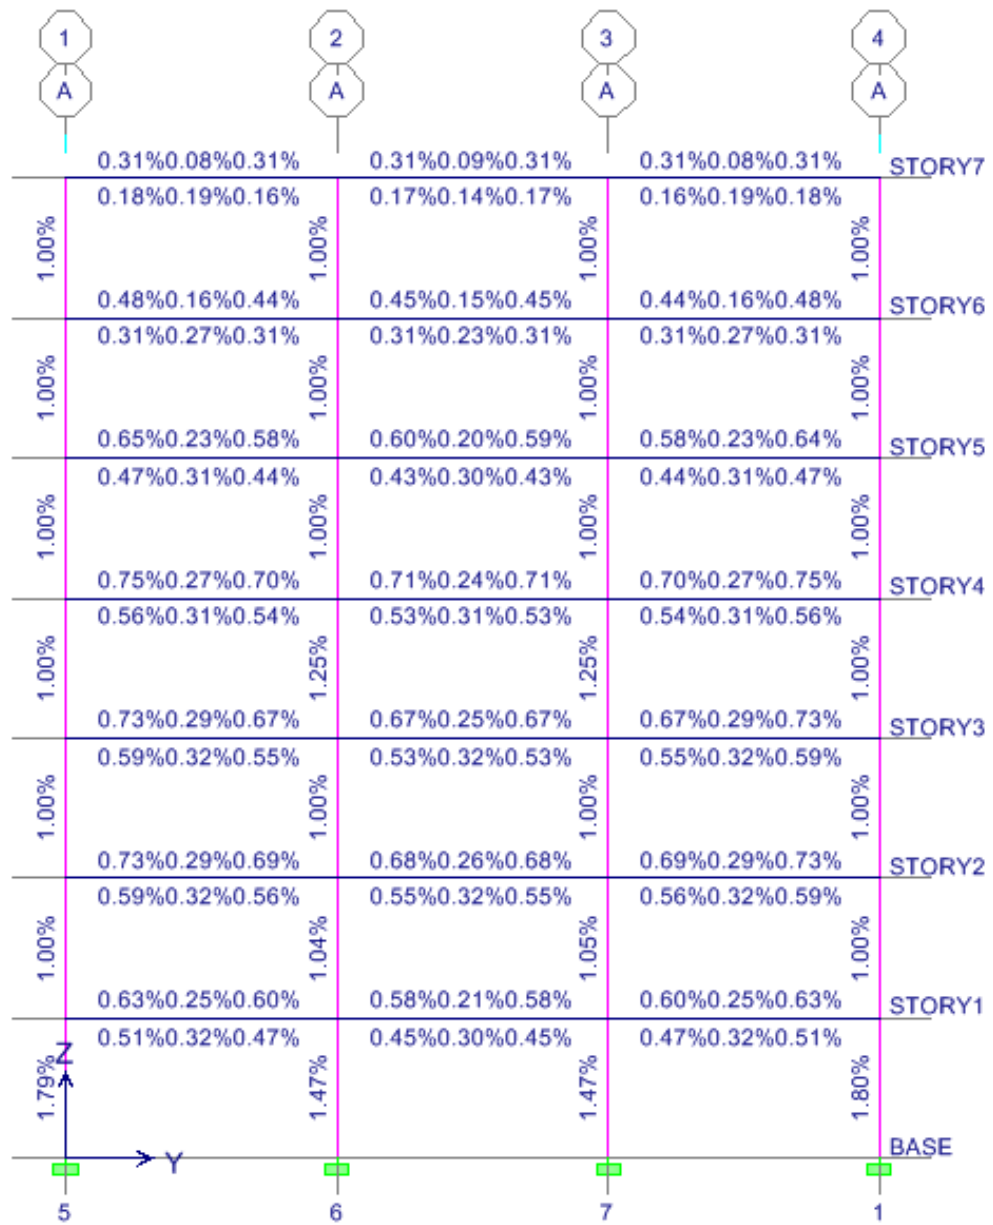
Detalle de la cuantía de refuerzo del edificio en elevación (pórtico A).
